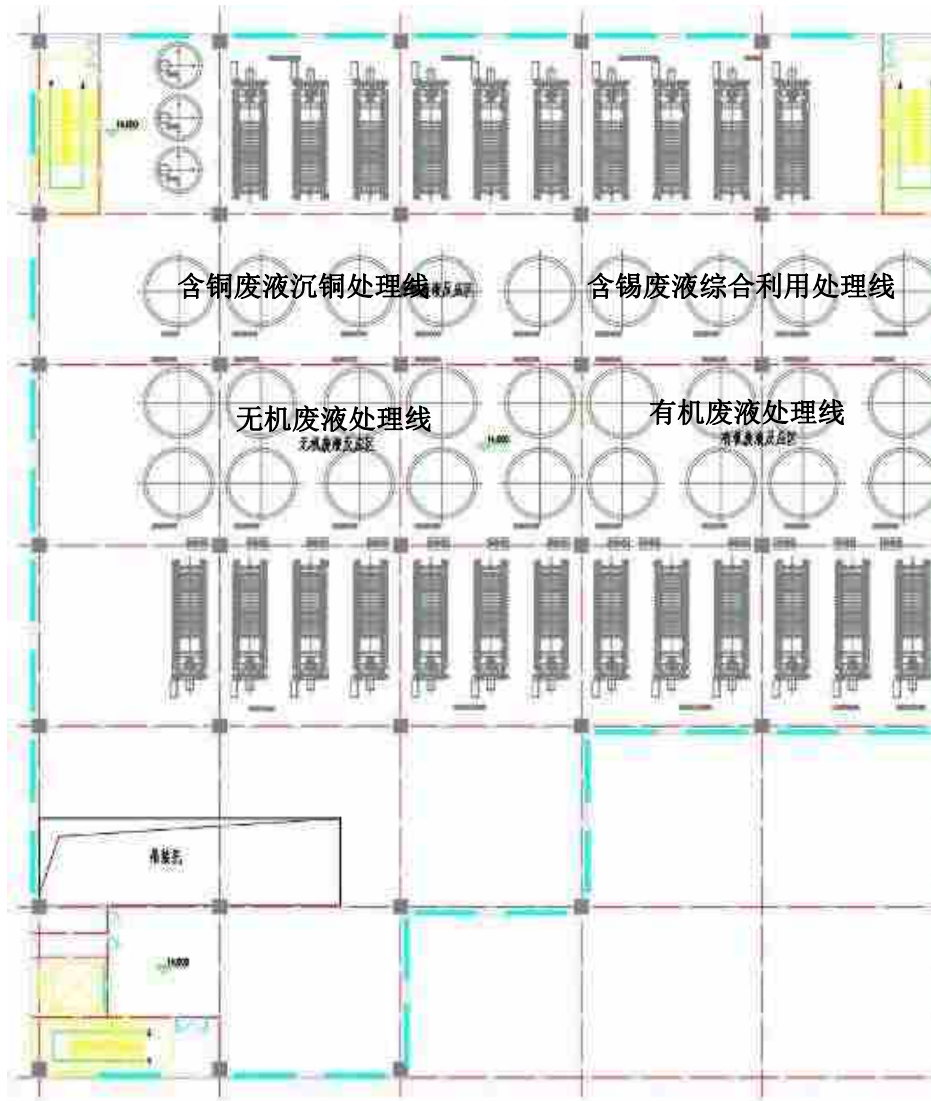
(3) 本次改扩建后 8#\*厂房 3 层平面布置图
